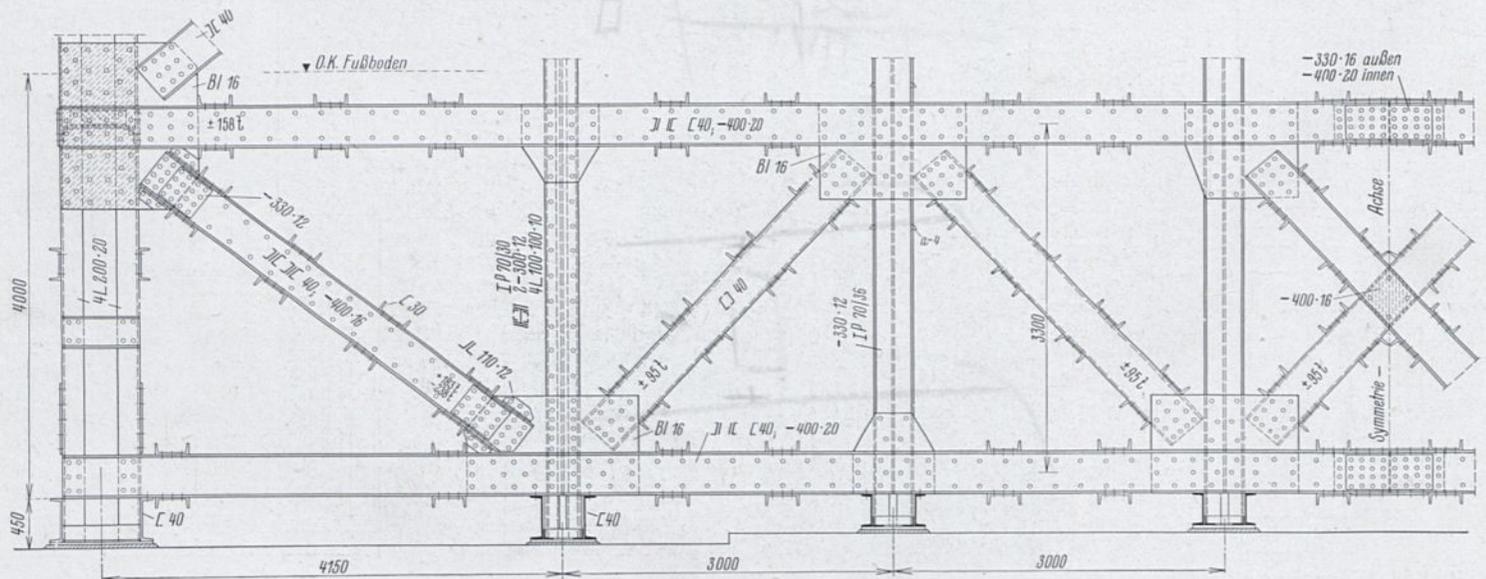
Fundamentriegel der Frontwandrahmen der Ehrenhalle.
